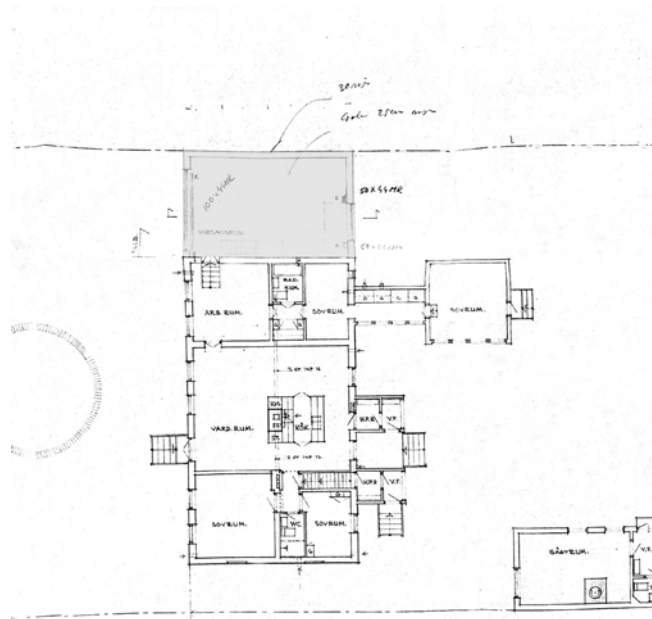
Planta de acceso de la casa de Kävlingevägen 32. El plano se corresponde con el estado final construido de la casa. En gris se oculta la parte que aún no estaría construida. En el plano se recogen las distintas actuaciones llevadas a cabo en distintos momentos. Se puede ver la pieza del dormitorio, unida a la construcción principal por un paso que sirve como vestidor. Tiene su propia salida hacia el jardín. Las ventanas se orientan hacia el sureste. Plano modificado por el autor. Arkdes.
